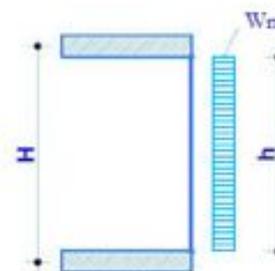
Расчетная схема стойки каркаса стены при воздействии ветровой нагрузки
